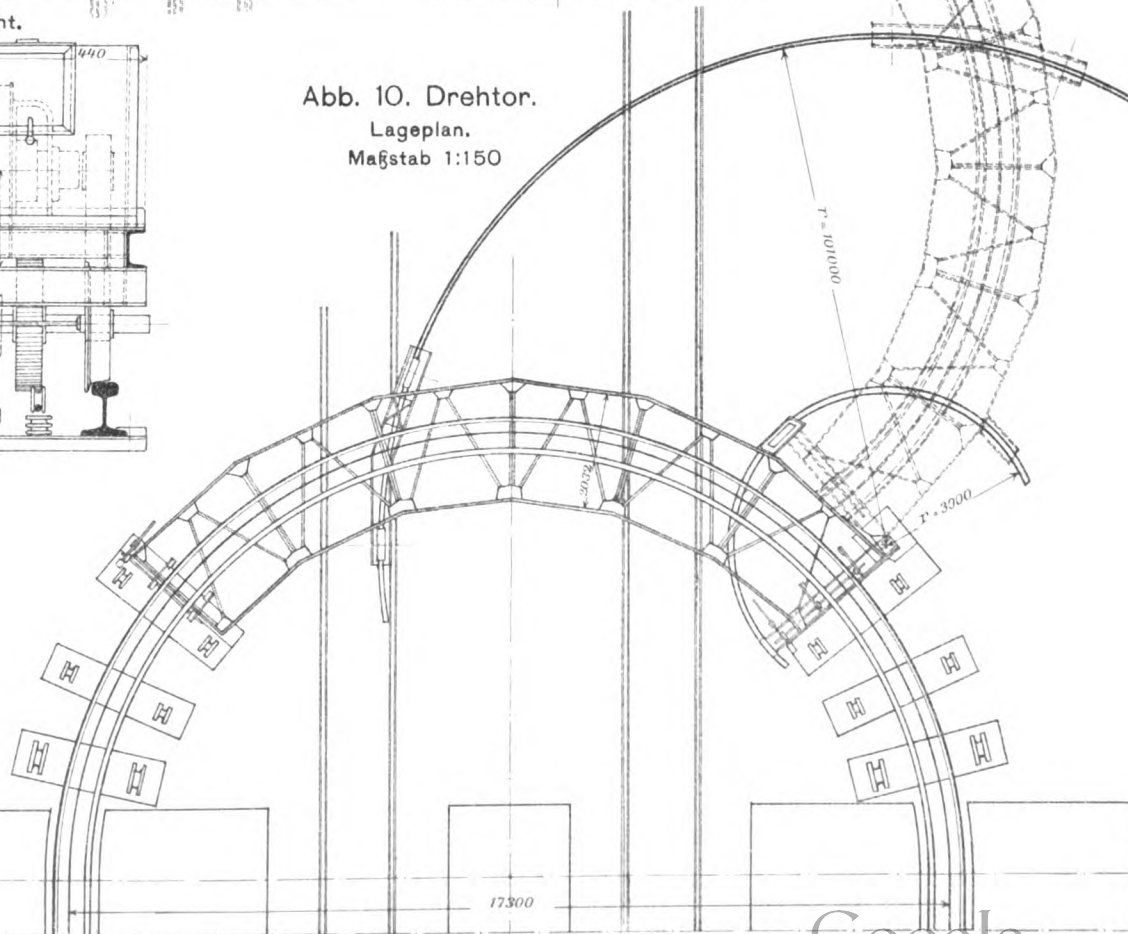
Drehtor. Lageplan. Maßstab 1:150
